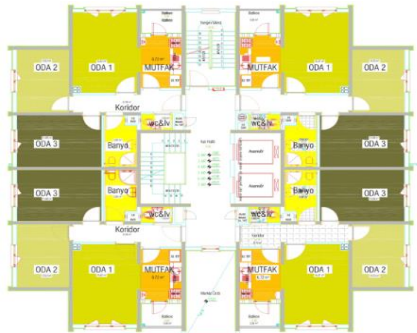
Araştırma yapılan konutların vaziyet planları (Site plans of buildings at each region)
